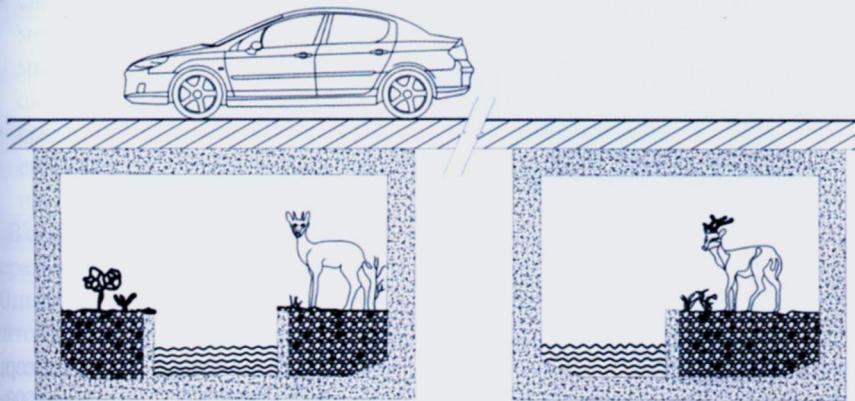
Схема тоннеля для животных с песчаным основанием и водотоком
